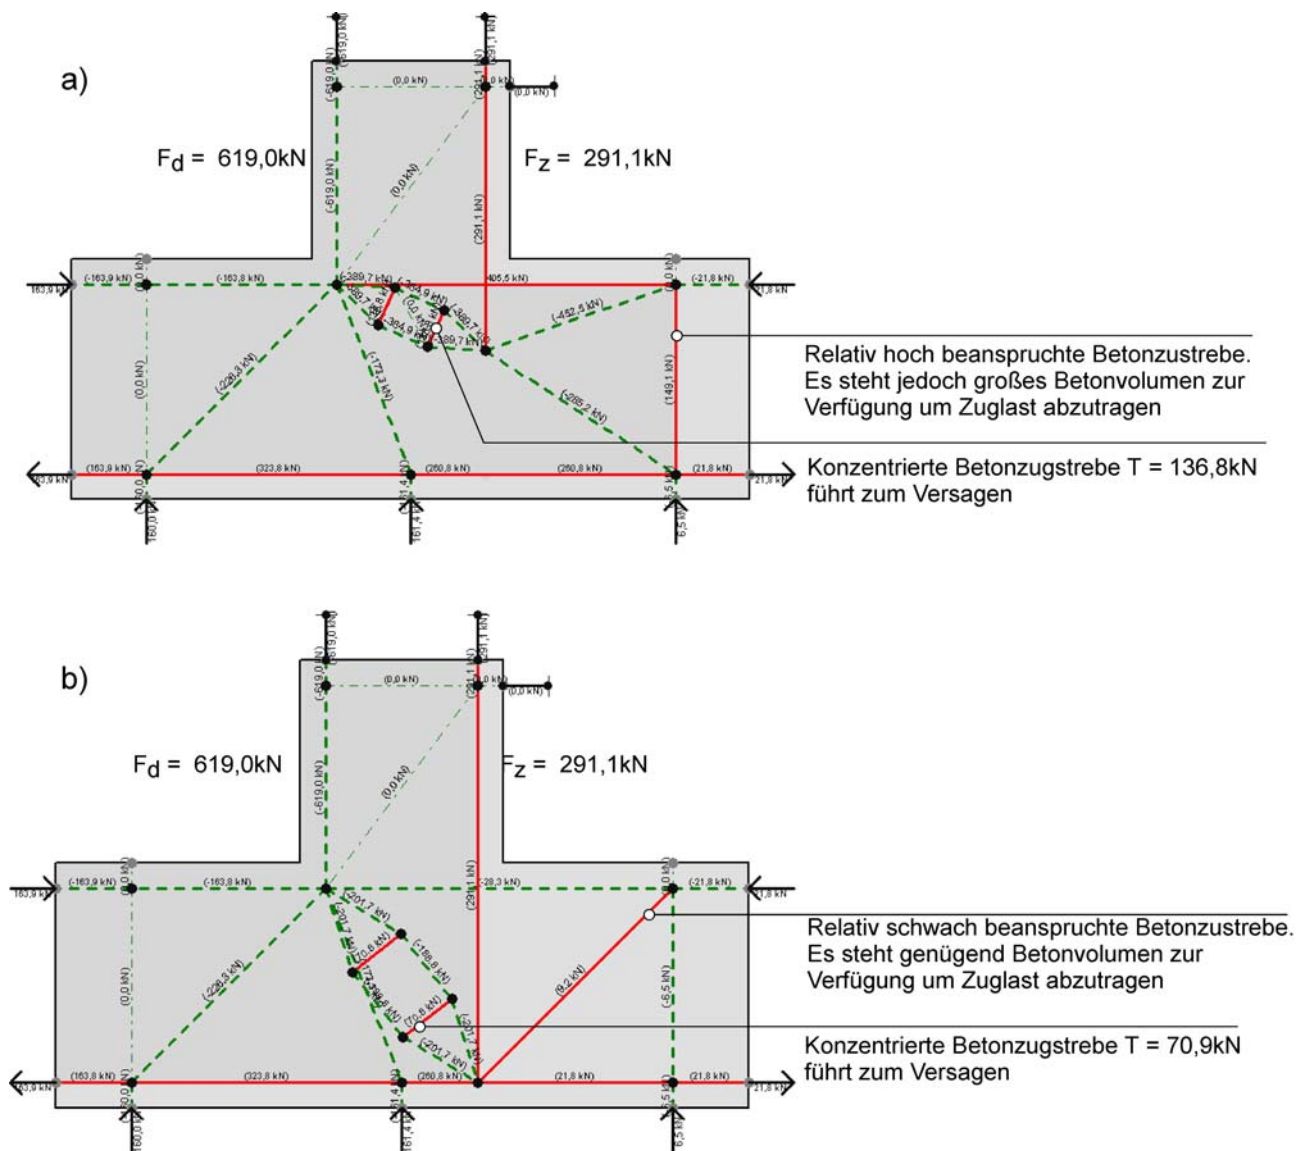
Stabwerkmodell einer Stütze-Fundament-Verbindung mit a) Ankerstäben und mit b) abgebogener Bewehrung
